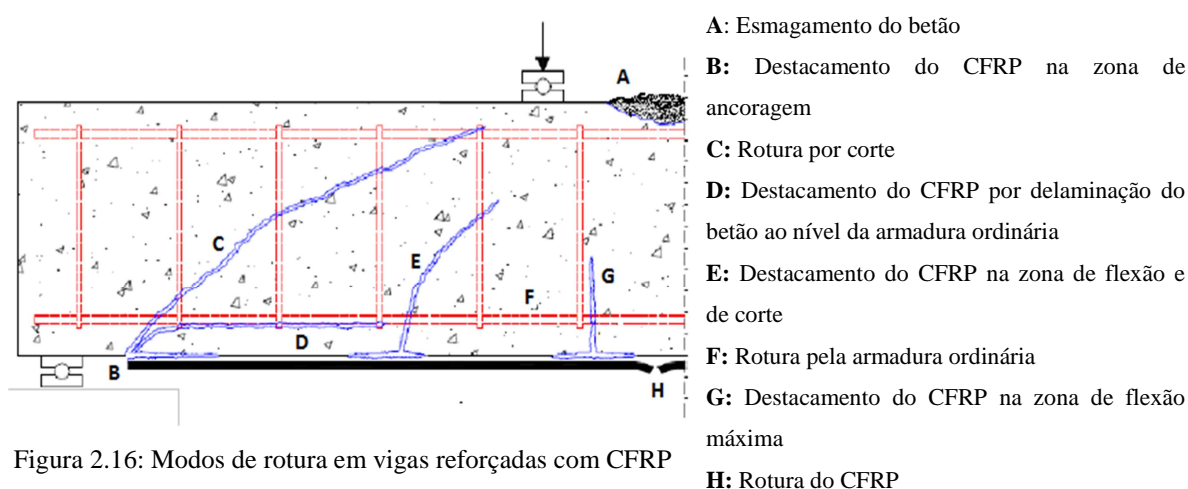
Modos de rotura em vigas reforçadas com CFRP
